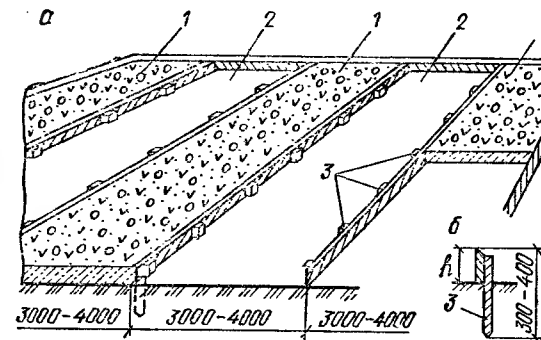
Схема бетонирования подстилающего слоя под пол
